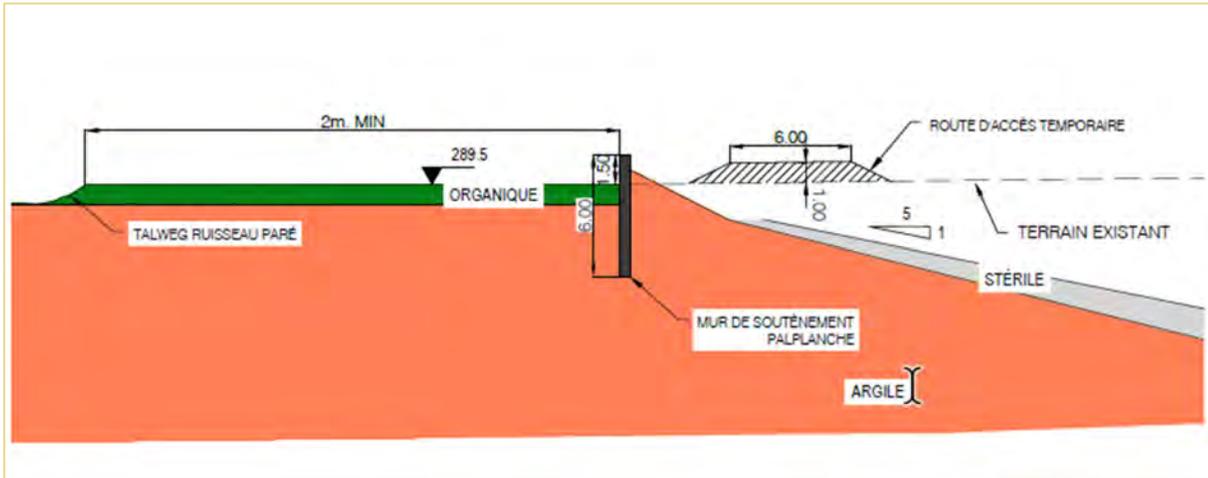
Vue en coupe - Mur de palplanches pour l'étanchéité de la fosse
